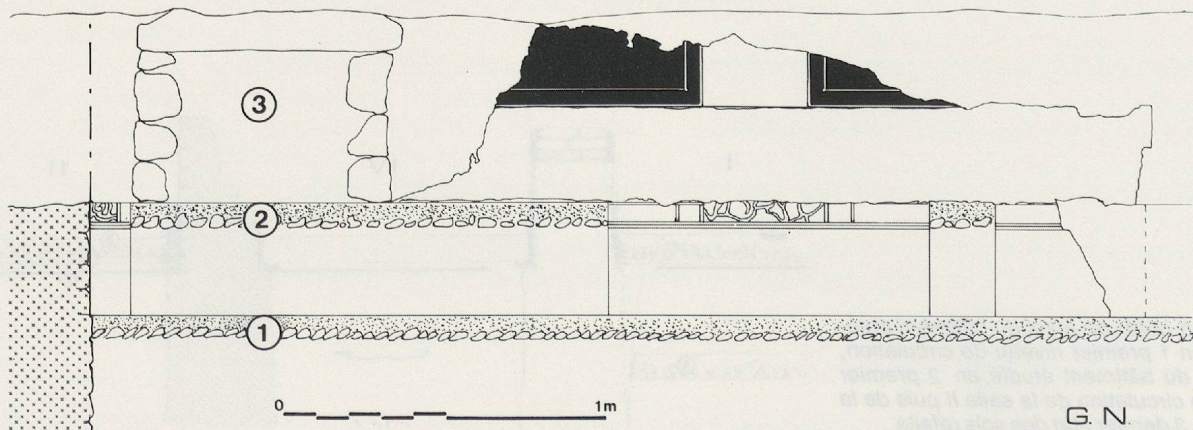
Salle V mur sud : en 1 sol du premier état, en 2 sol du deuxième état, en 3 reconstruction antique après dérasement du bâtiment
